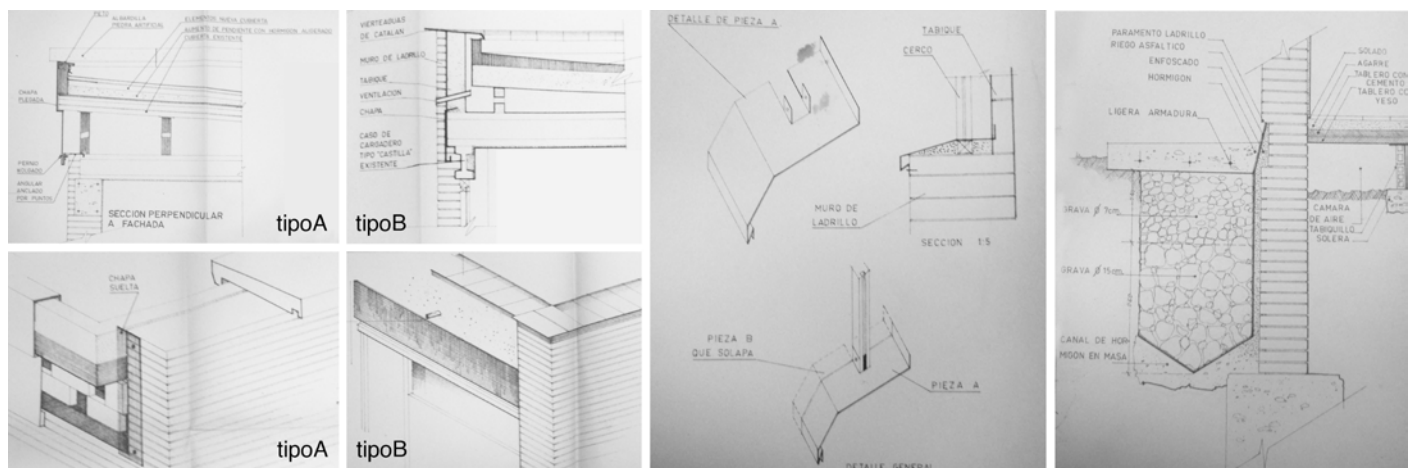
A. Detalles constructivos tipo A y B. B. Detalles constructivos pieza especial babero hueco ventana. C. Corrección del drenaje de muro perimetral. Investigación “corrección” sobre el P.D. de Canillas. 1963 [47]
